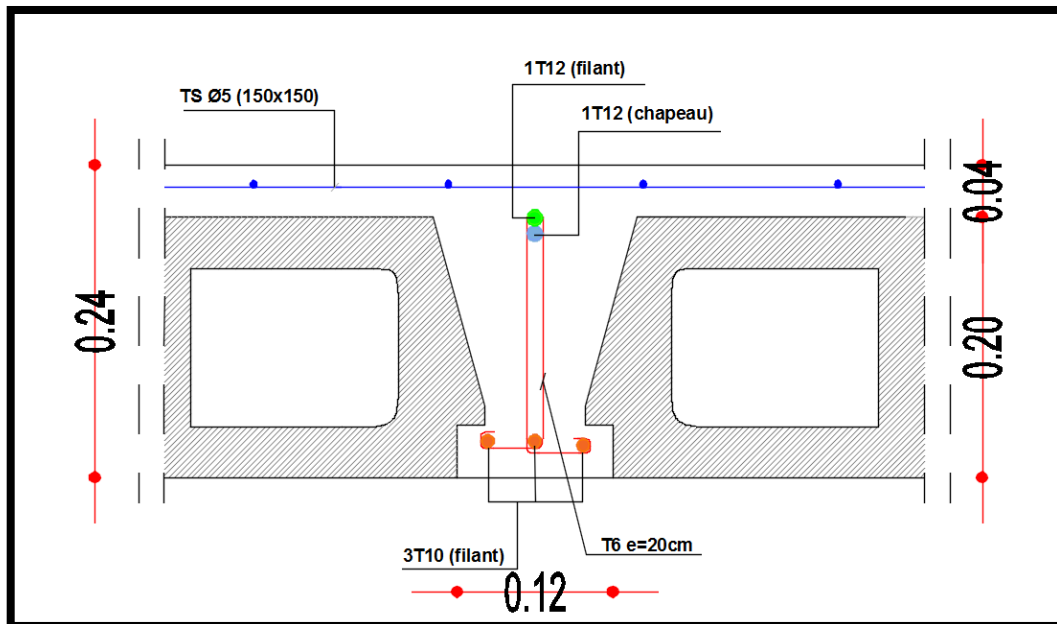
Schéma du ferrailage de la poutrelle (étage courant)
